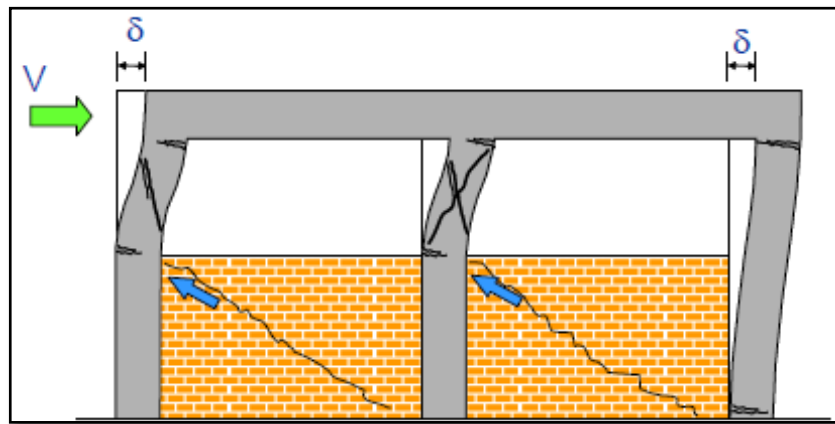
Esquema de Fallas por el Efecto de Columna Corta.
